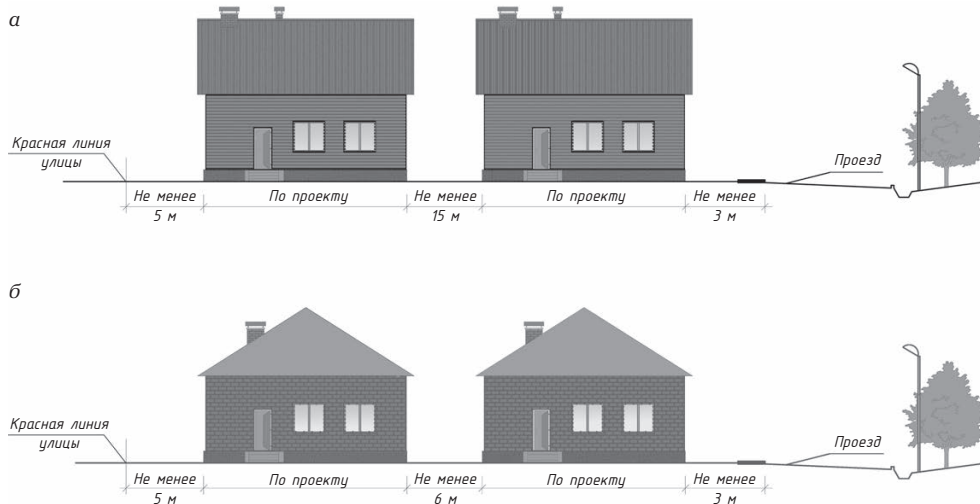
Нормативные расстояния между домами, красными линиями, проездами: а — дома с деревянными стенами; б — дома с каменными стенами и монолитными перекрытиями
